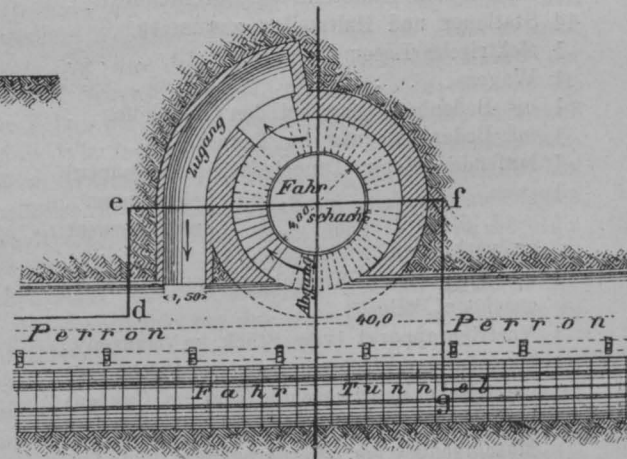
Grundriss einer eingleisigen Schleifenstation.
